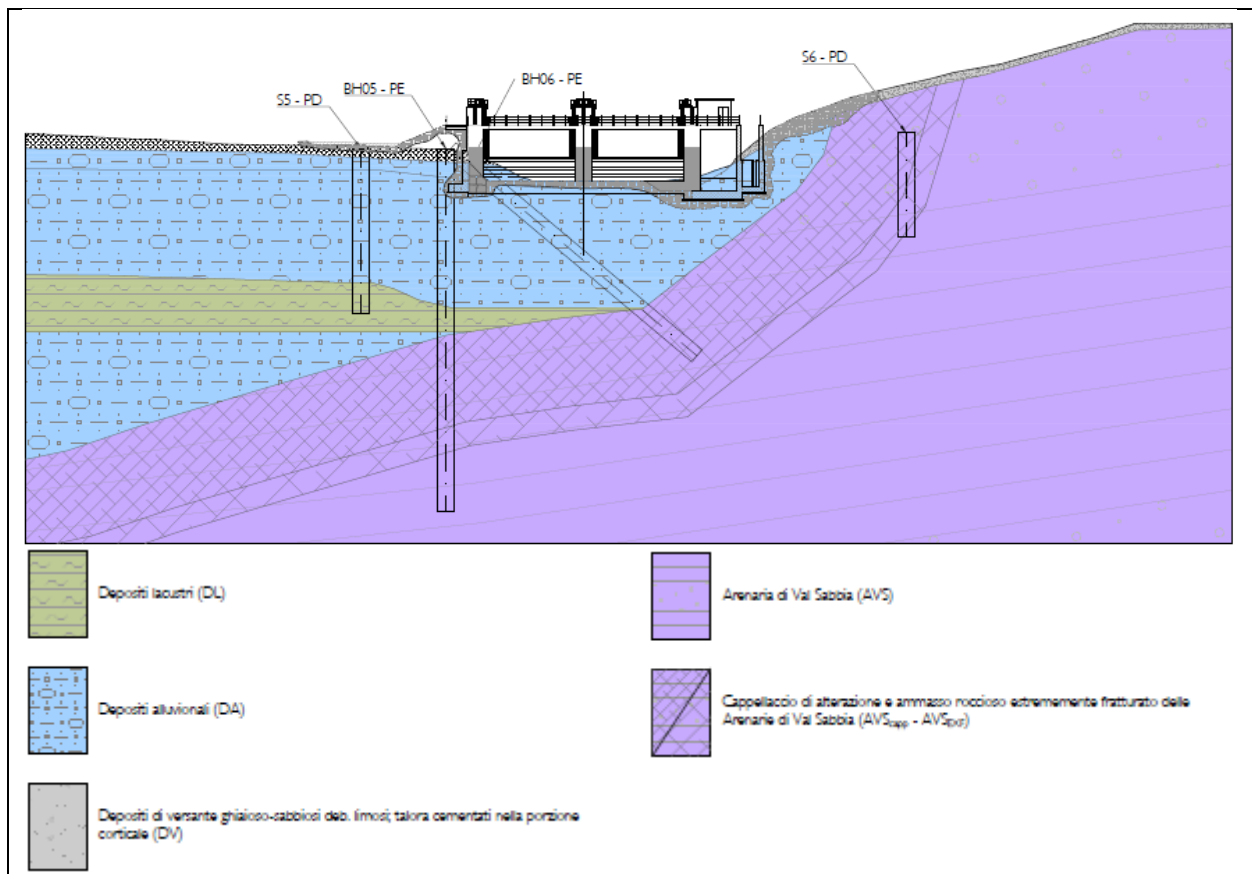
Sezione geologica in asse alla nuova traversa di progetto
